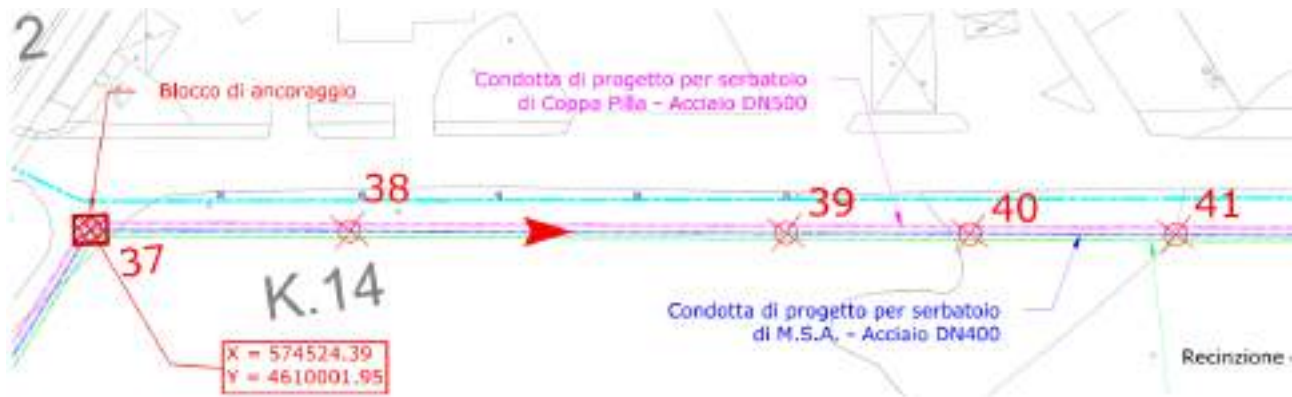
Stralcio planimetria interferenze (in colore celeste la rete gas) tra picchetto 37 e 41
